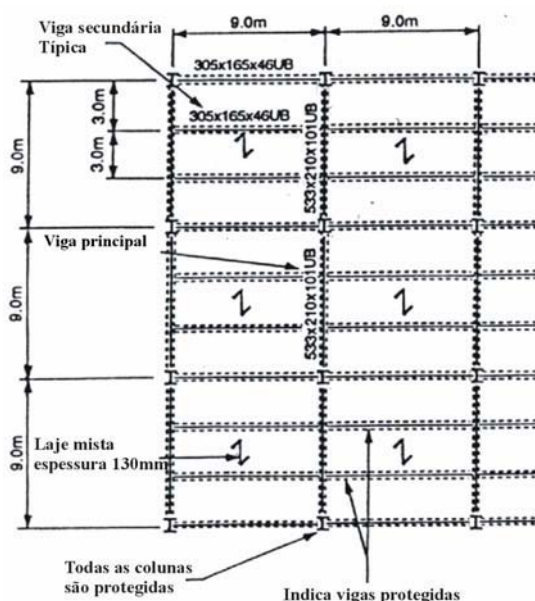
Painel de laje de 9m x 9m, com todas as vigas protegidas
